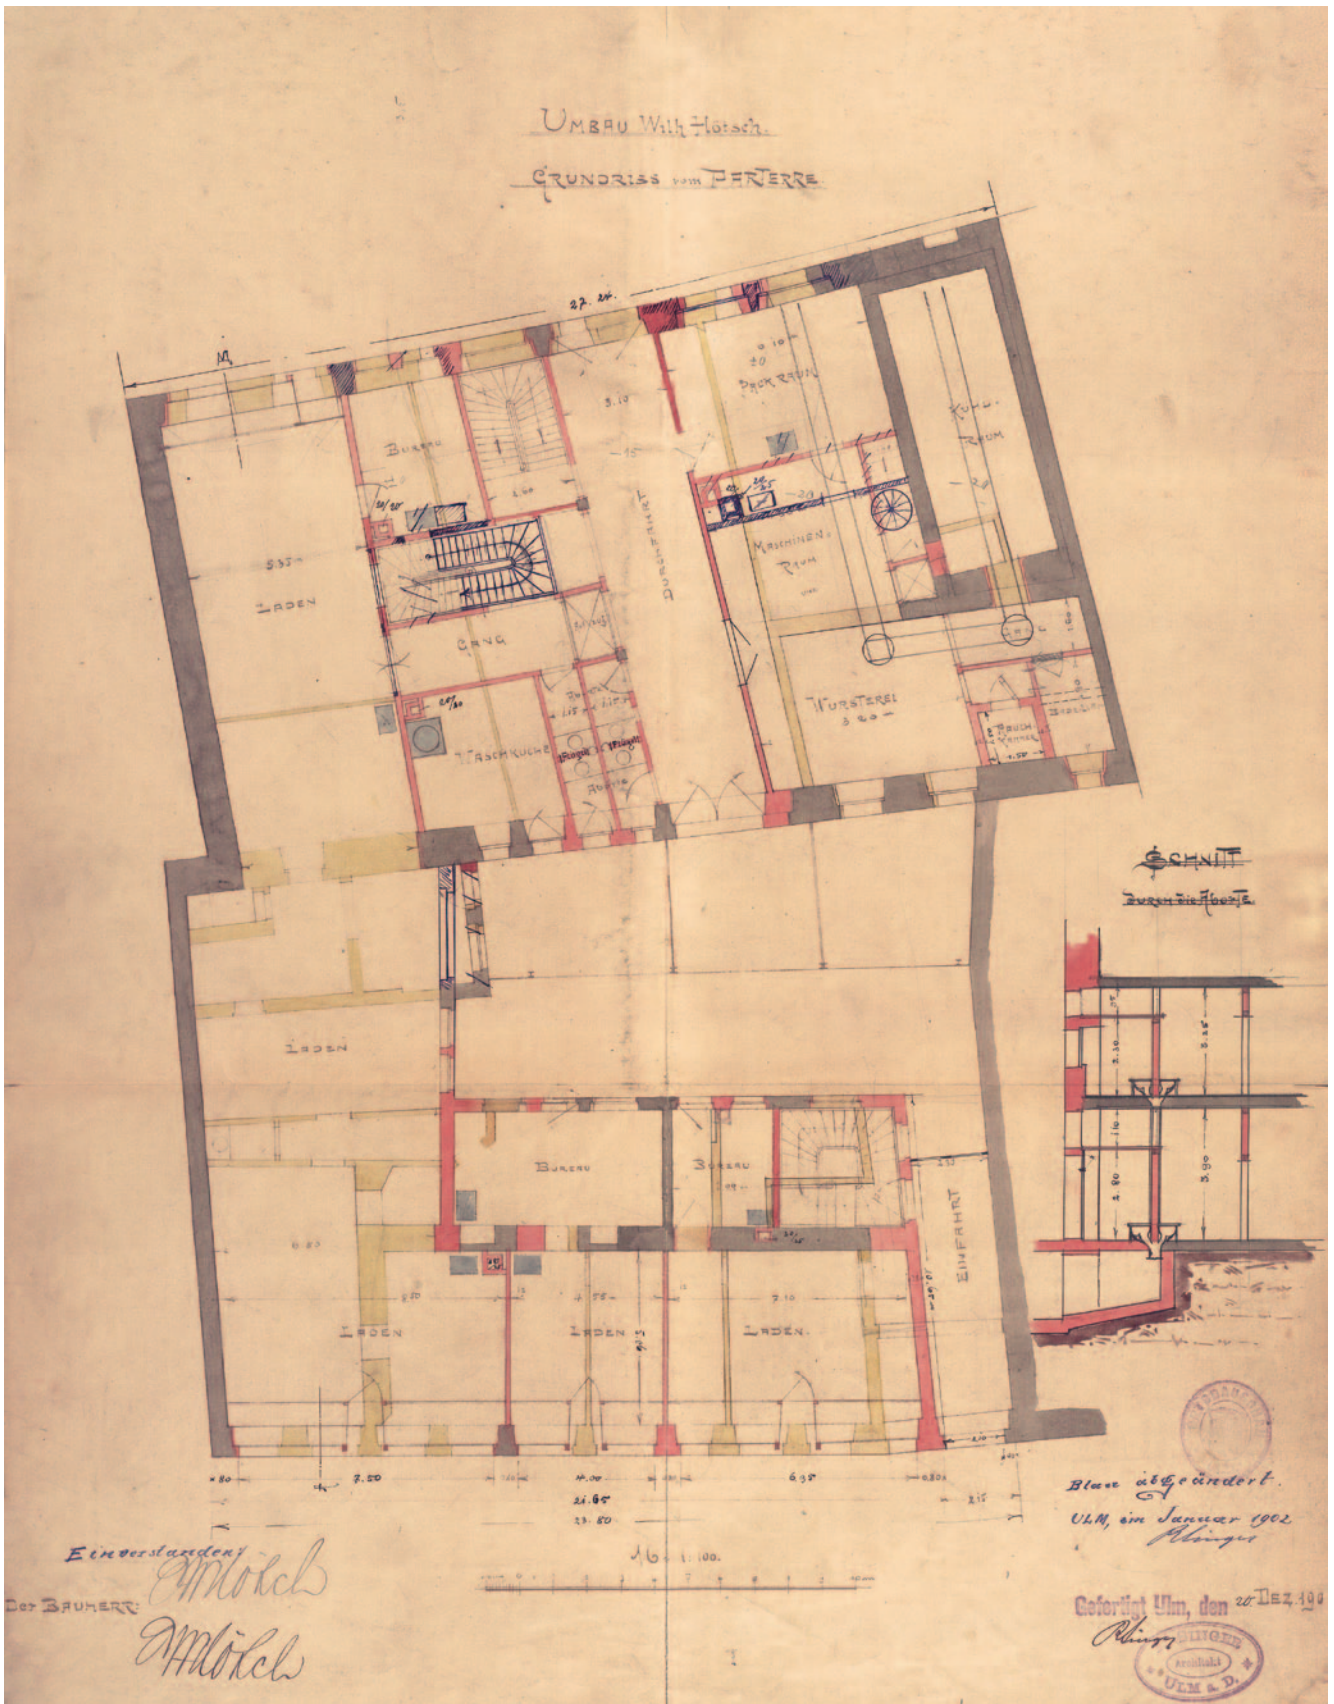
Gebäude Lange Straße 16 (A 261), Erdgeschossgrundrissplan zum Umbau des Vorder- und Hinterhauses, Baugesuch 1901, 2. Fertigung.
